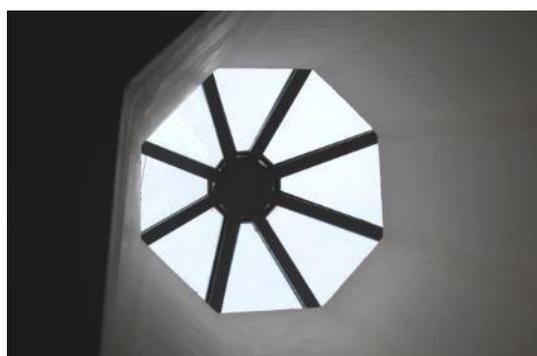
Claraboia em ferro e vidro laminado (Porto Vivo, SRU)
